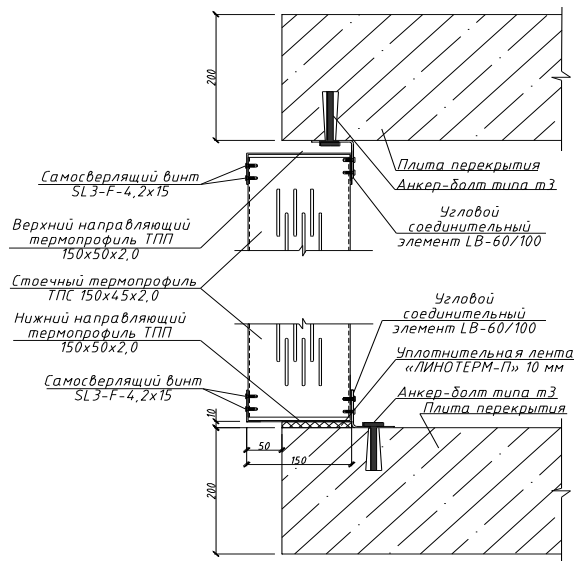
Крепление каркаса термopanели к перекрытию
